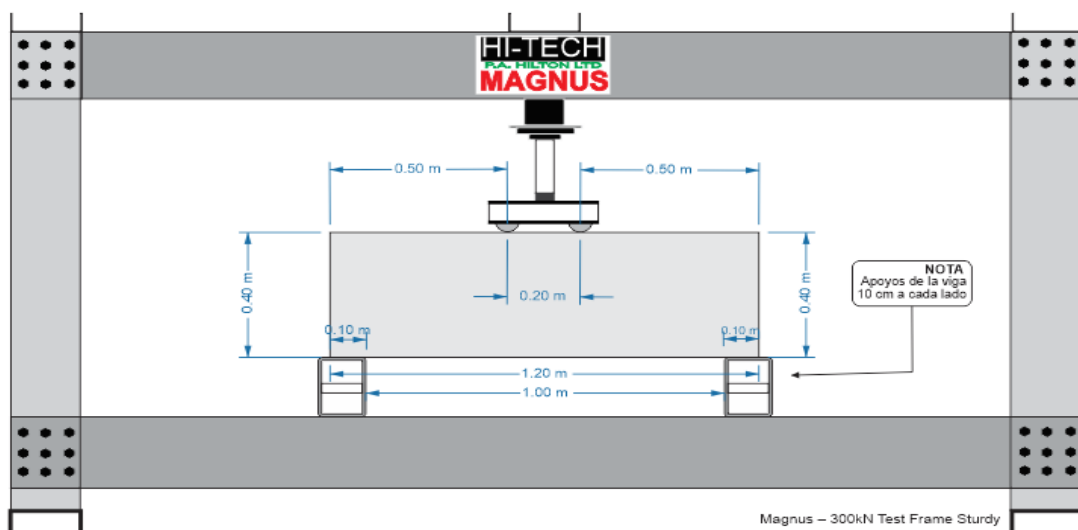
Detalle del modelo de ensayo aplicado a las vigas de gran altura.
